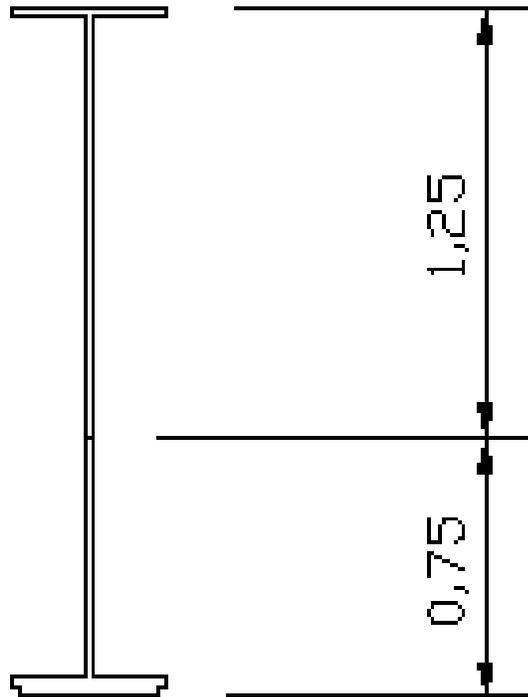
Diseño de viga metálica con losa colaborante. Sección viga en etapa de montaje.
